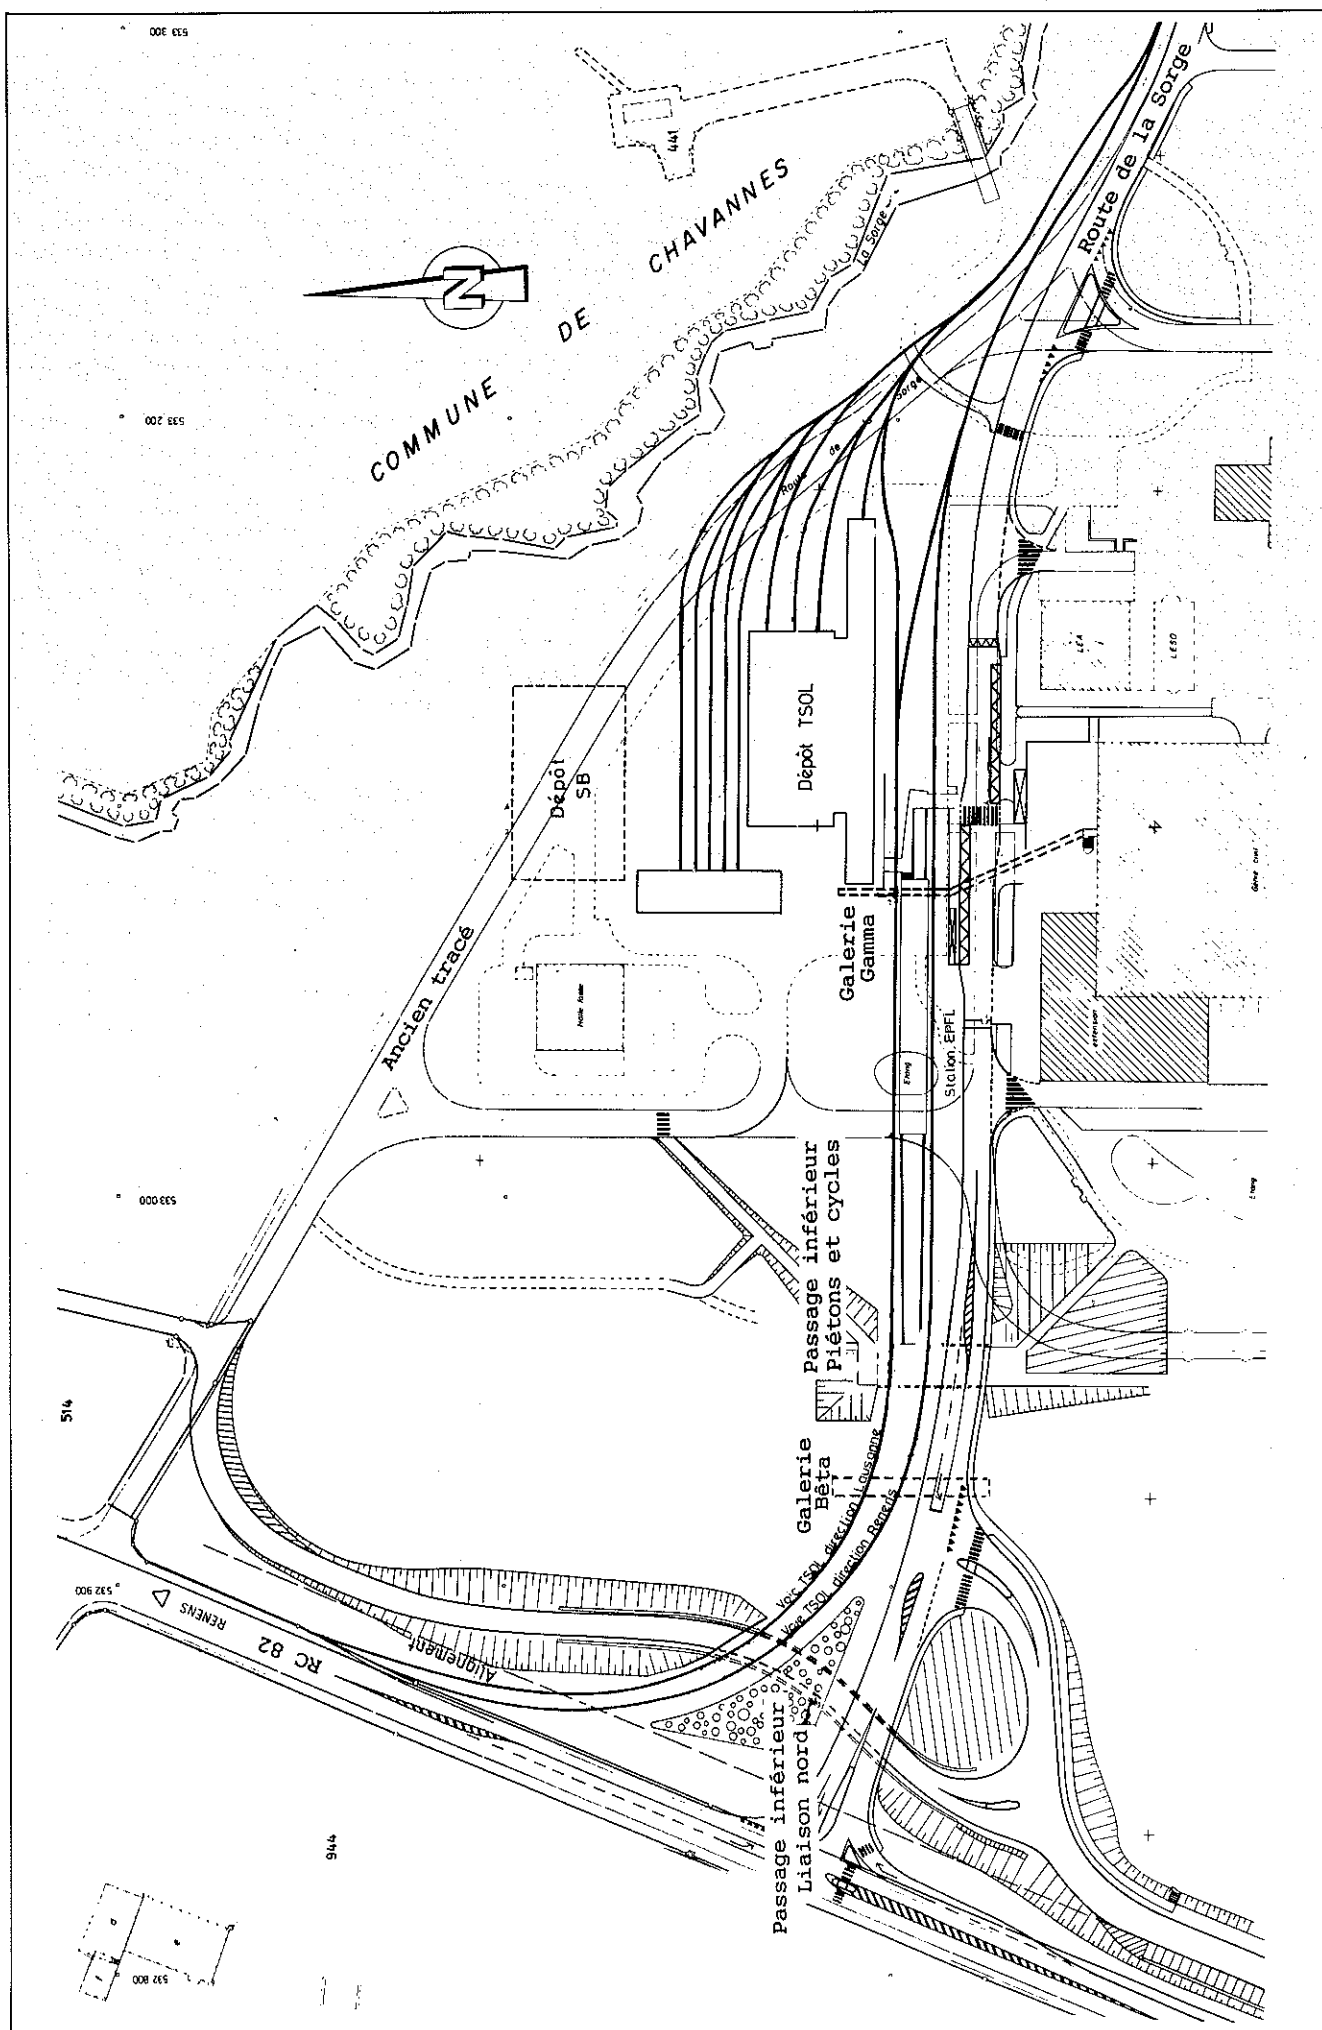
Aménagement du secteur de l'EPFL: plan général.
